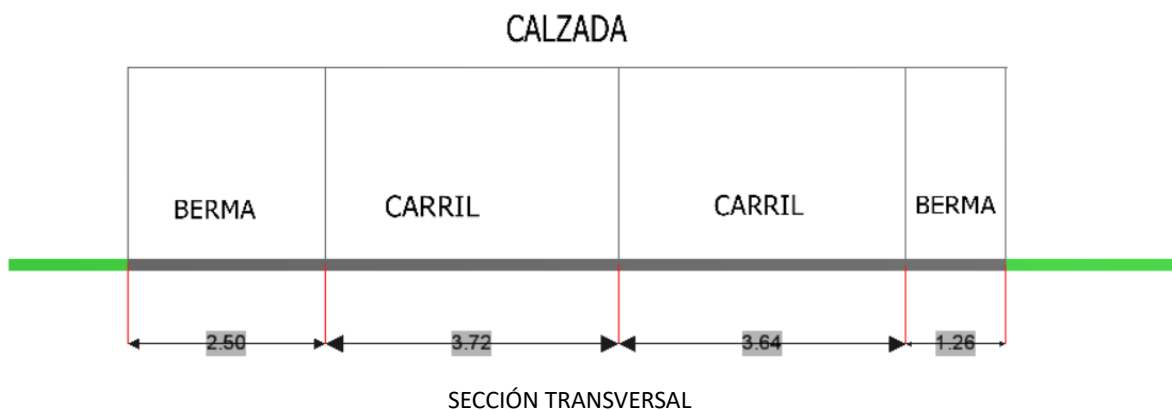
Sección transversal de la vía carrera 12, entre calle 10 y 11.
